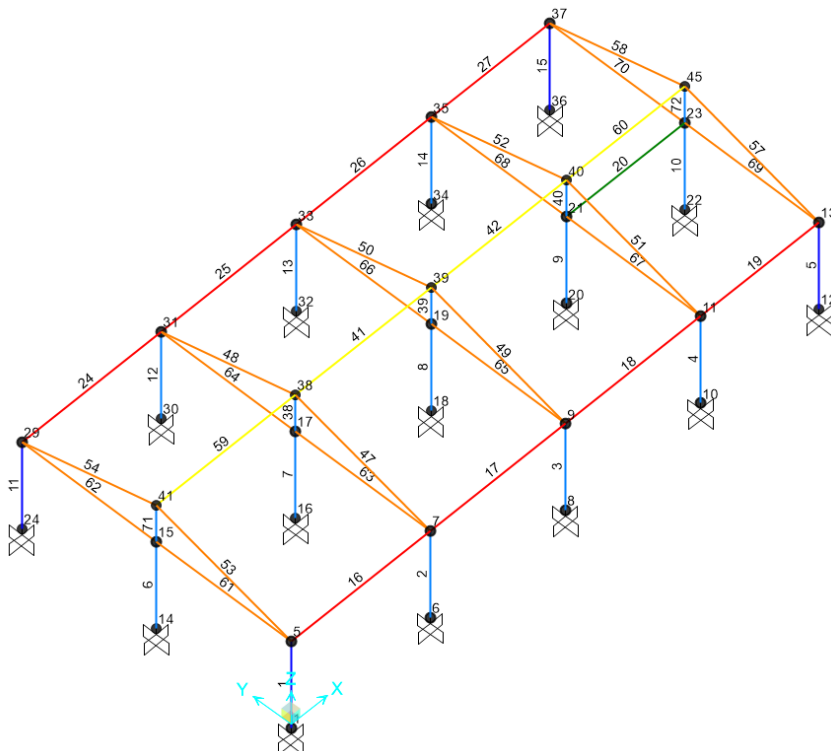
Vista assonometrica modello struttura in elevazione - numerazione elementi frame
